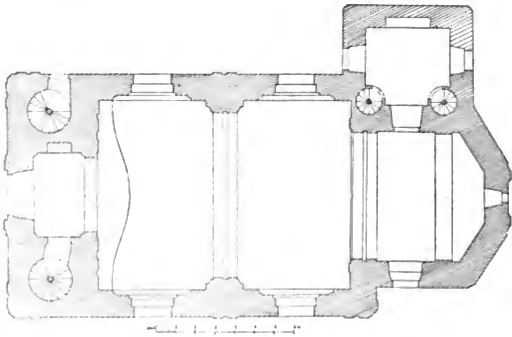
Šemanovic. Grundriss der Kirche.
